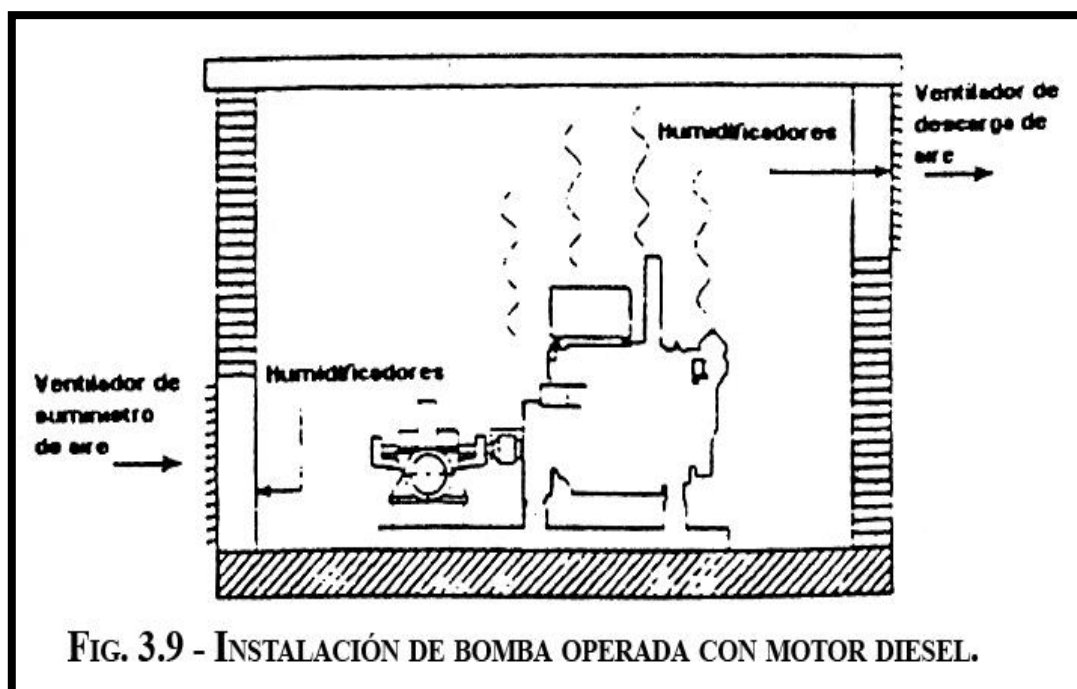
INSTALACIÓN DE BOMBA OPERADA CON MOTOR DIESEL.
